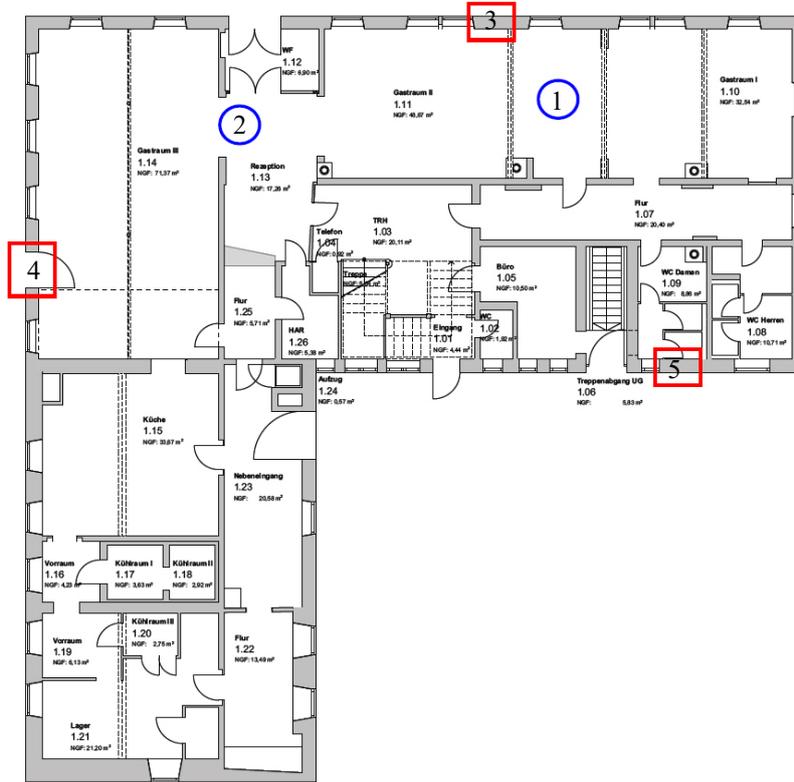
Lage und Nr. der Bauteilöffnungen an der Decke über EG (blau: Deckenöffnungen, rot: Auflageröffnungen)
